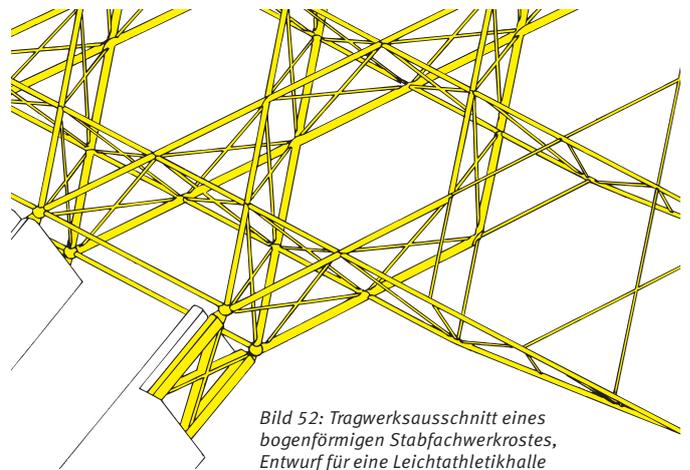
Tragwerksausschnitt eines bogenförmigen Stabfachwerkrostes, Entwurf für eine Leichtathletikhalle
